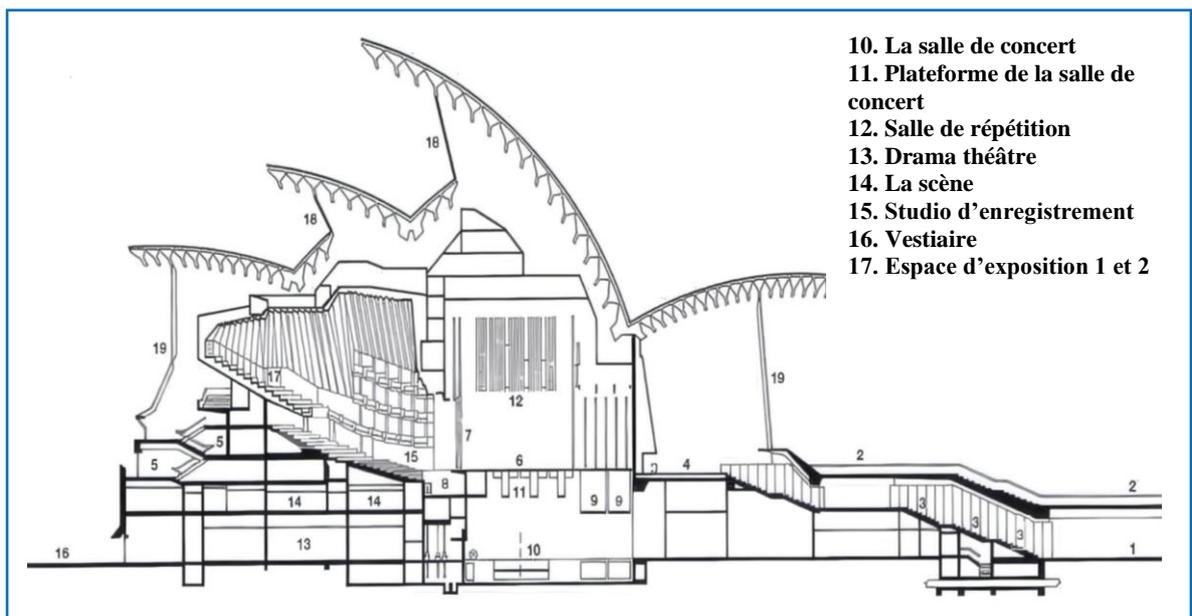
Coupe longitudinale sur le Théâtre Hall.
